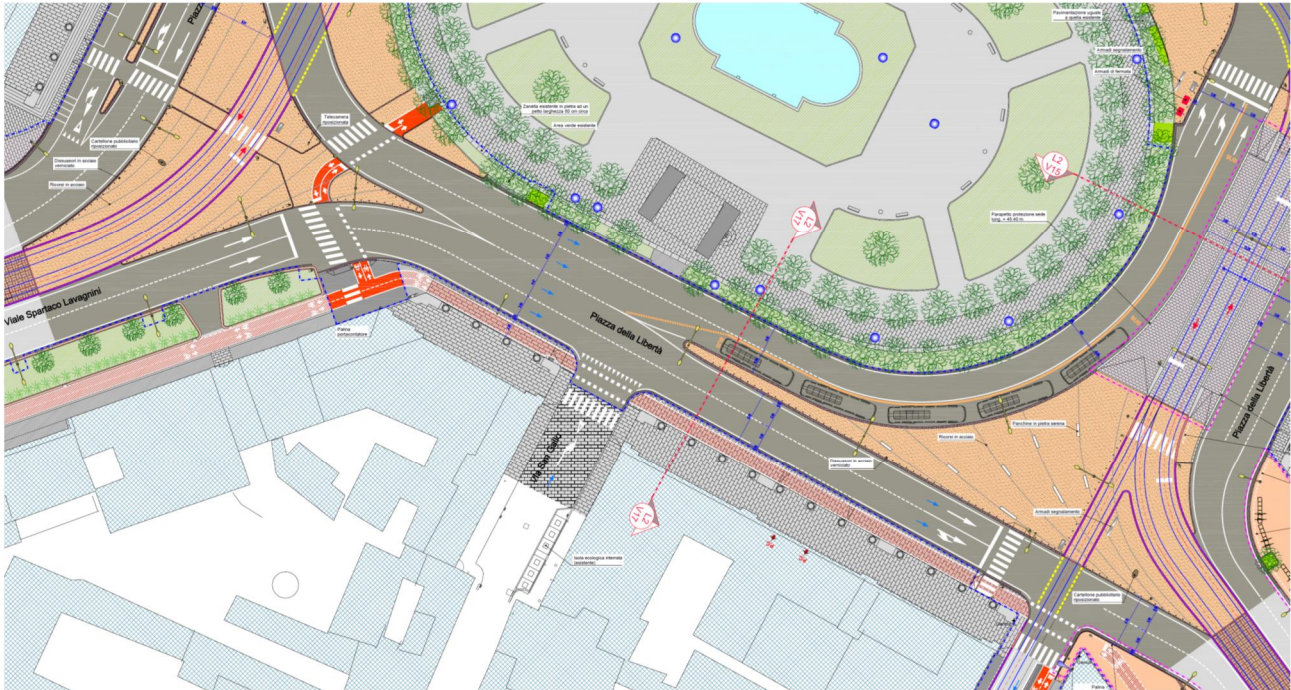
Stralcio planimetrico progetto della zona sud della piazza
